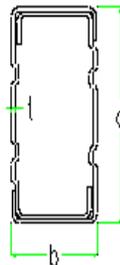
Geometría de Viga "O" 2"x5"x2.0mm
